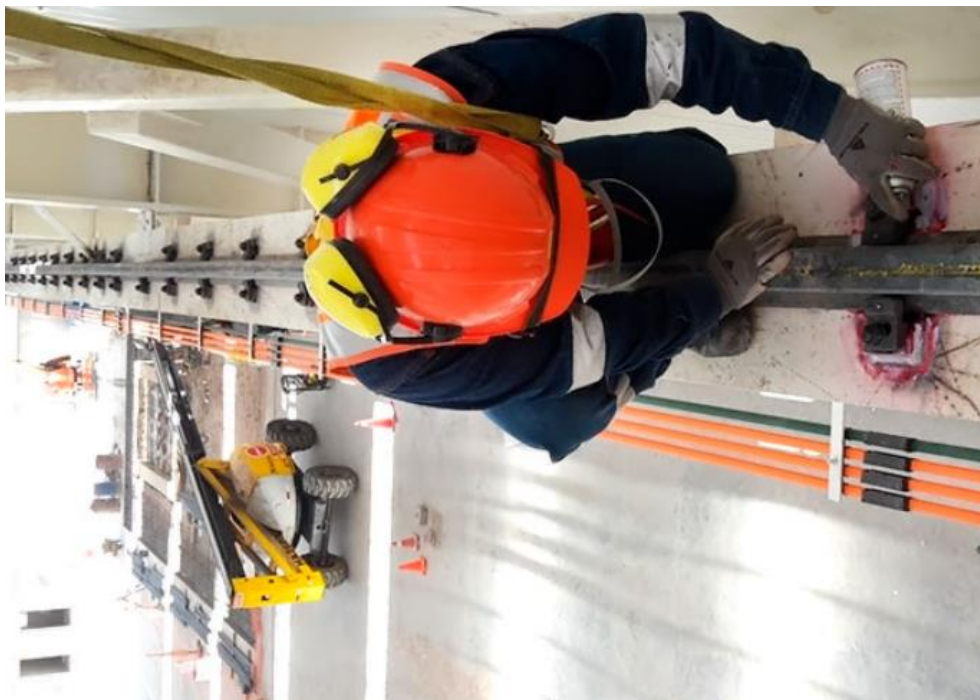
Instalación de sistema eléctrico de viga carrilera área 600 m.
